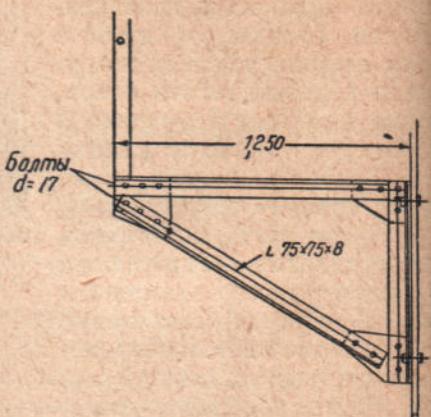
Металлический кронштейн для сборки кожуха печи и кауперов
